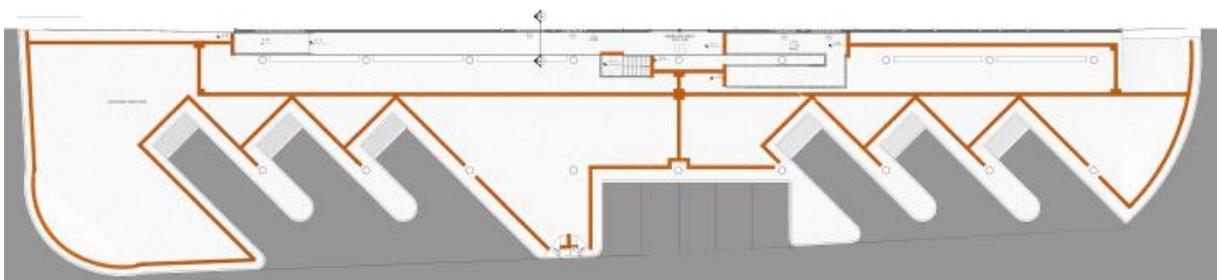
Esboço da planta baixa do Terminal Rodoviário
